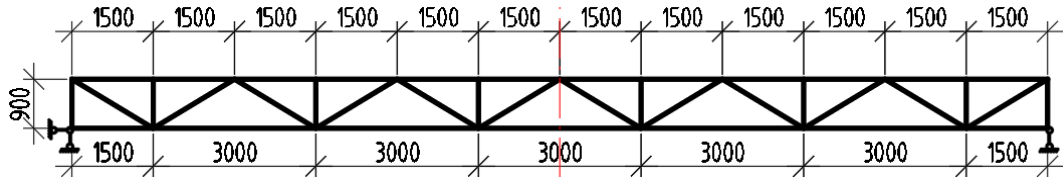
Балочная ферма 1 (грузовой пояс – верхний, узловая нагрузка 3 кН, 1.5 кН)
